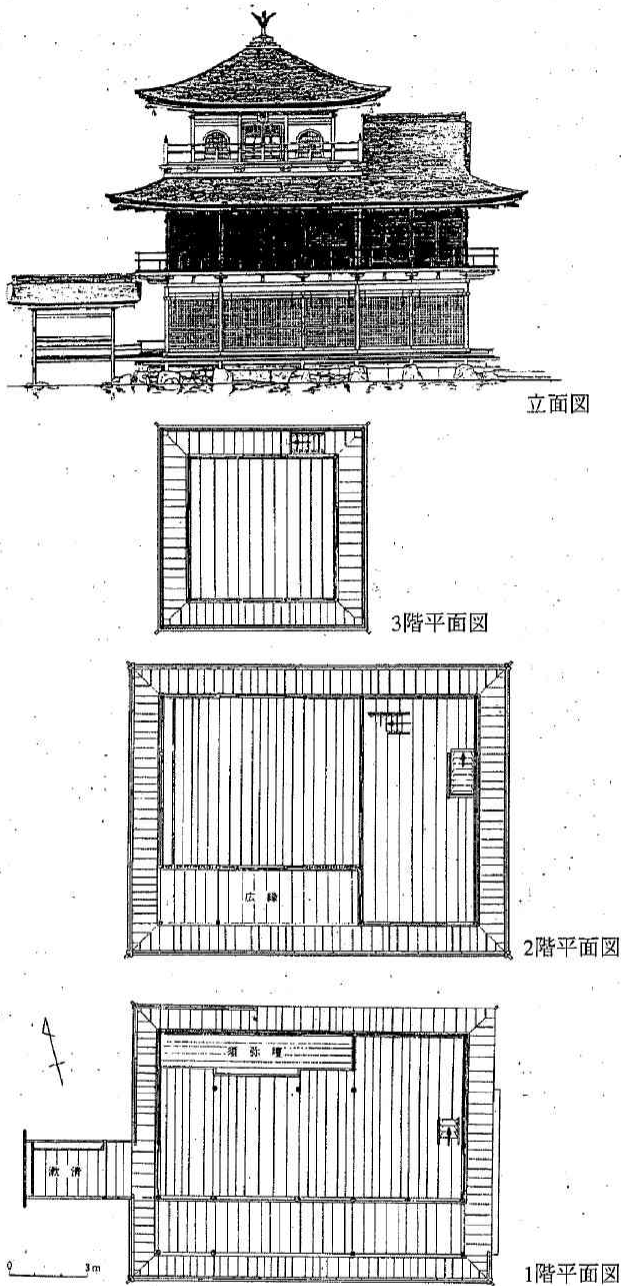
復元金閣南面立面図及び平面図（宮上茂隆作成）
